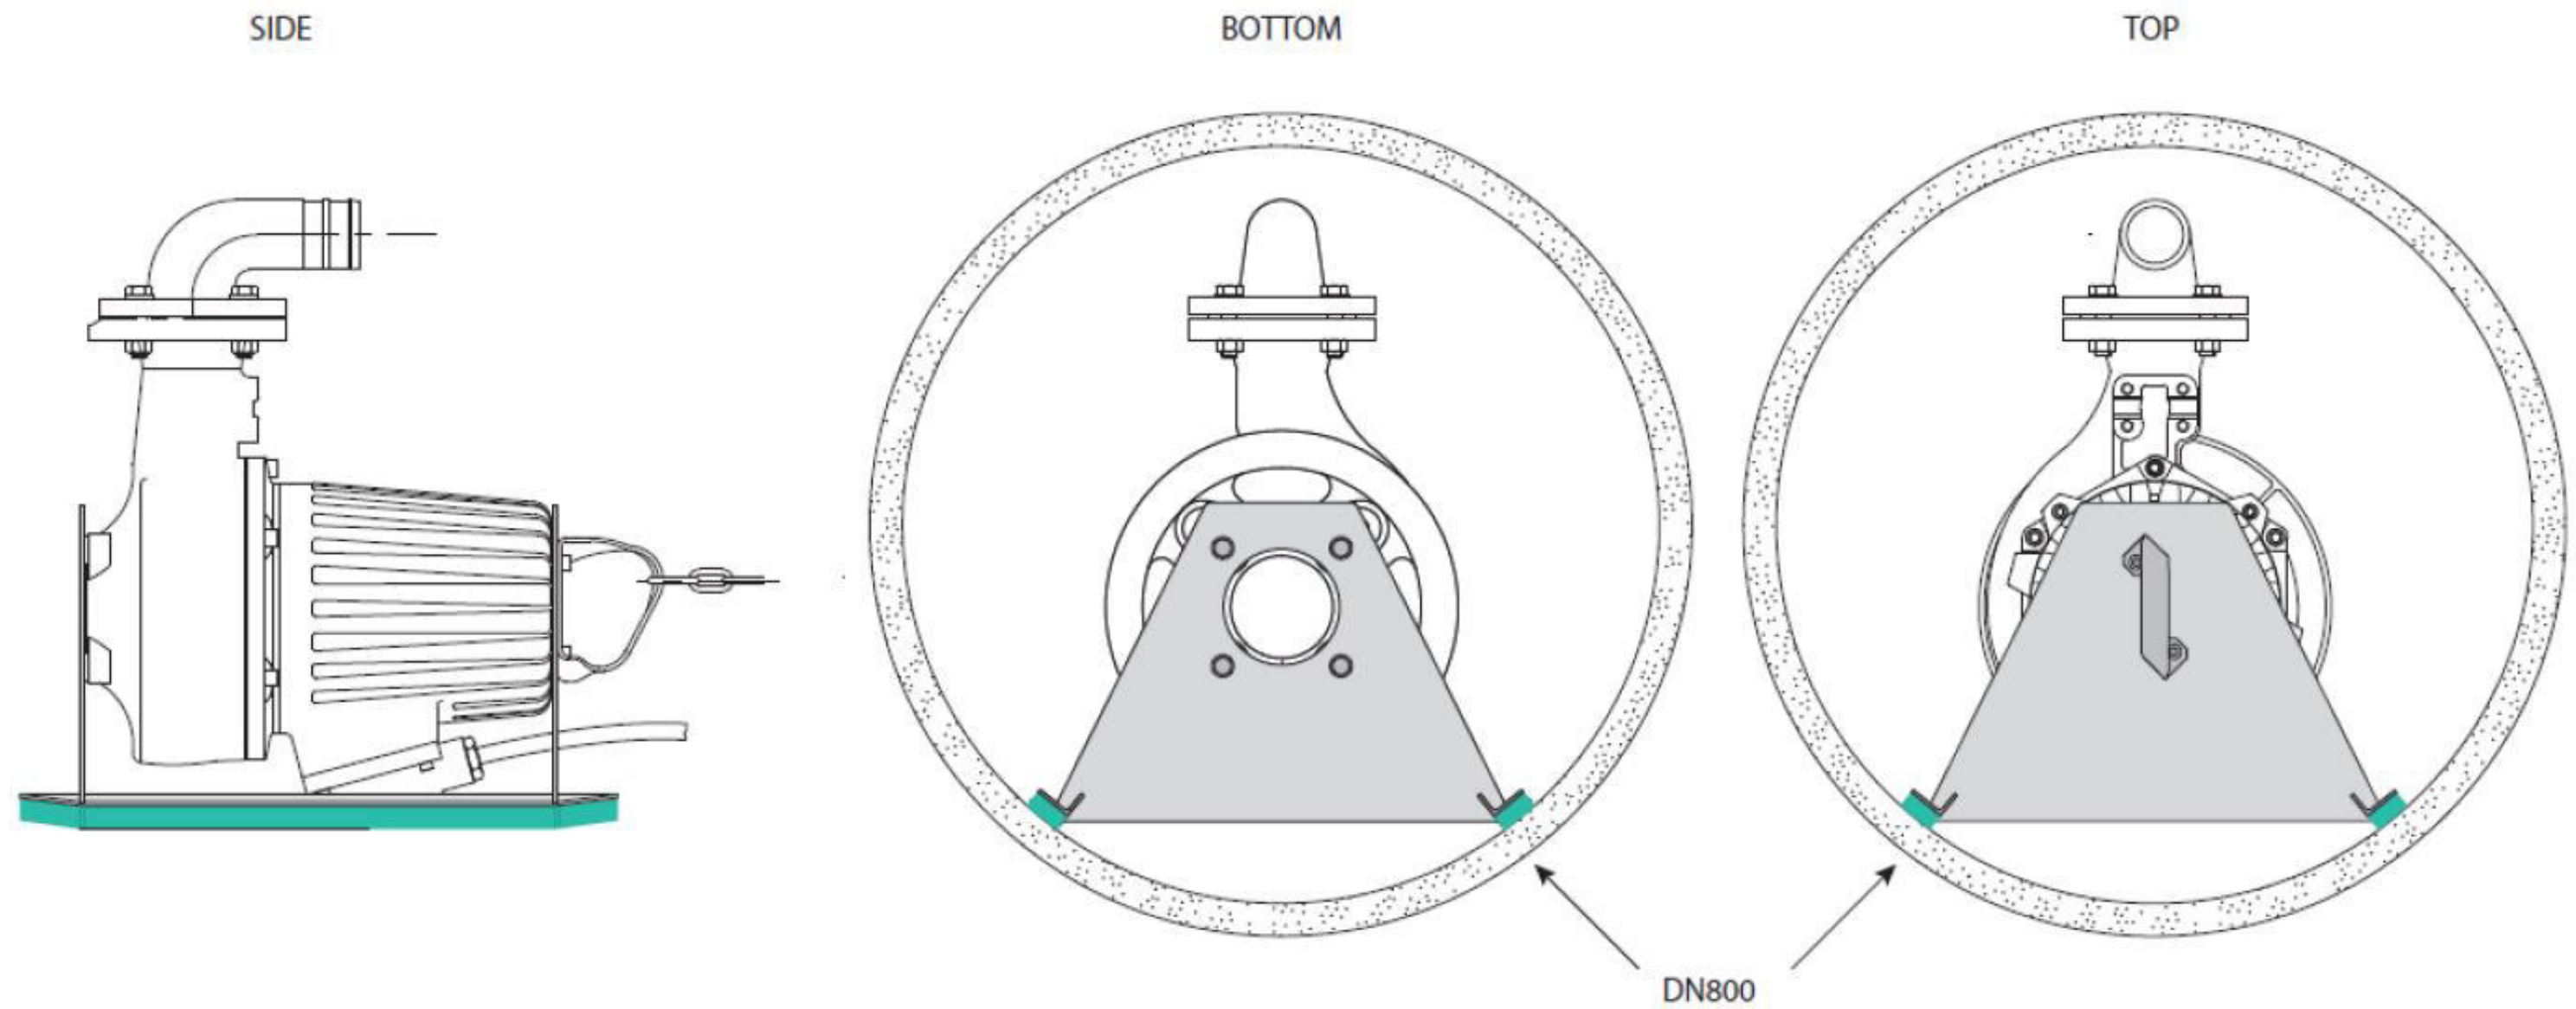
Slitta di posizionamento e estrazione delle elettropompe
